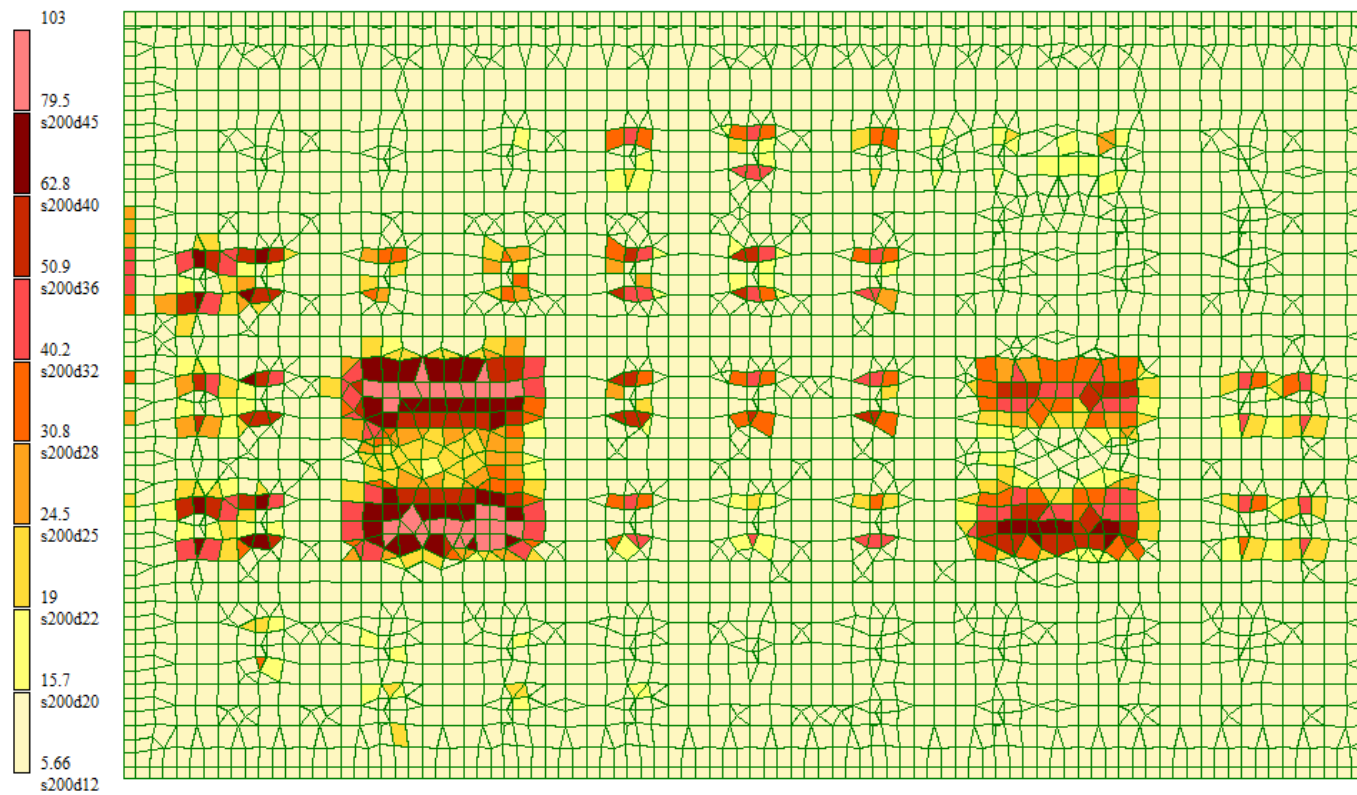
Схема армирования низа фундаментной плиты по оси OX и по оси OY
